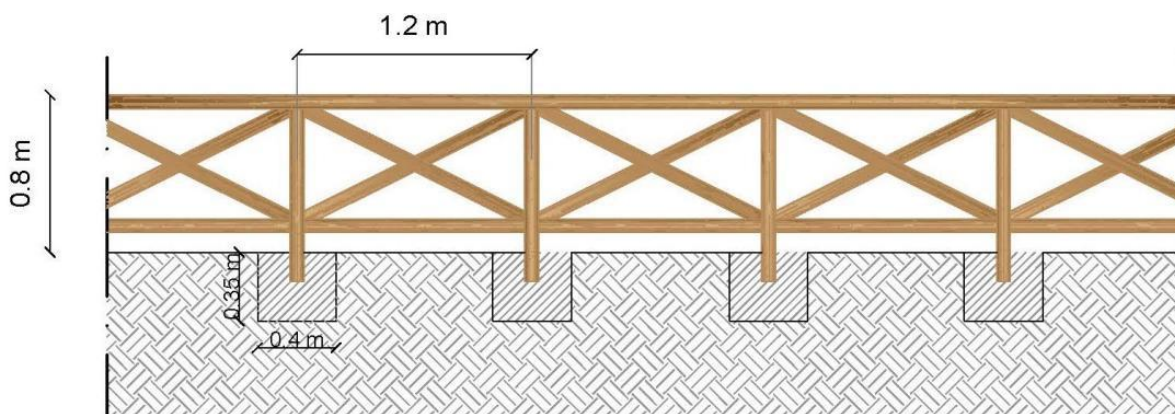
Parapetto in moduli smontabili in acciaio e legno
